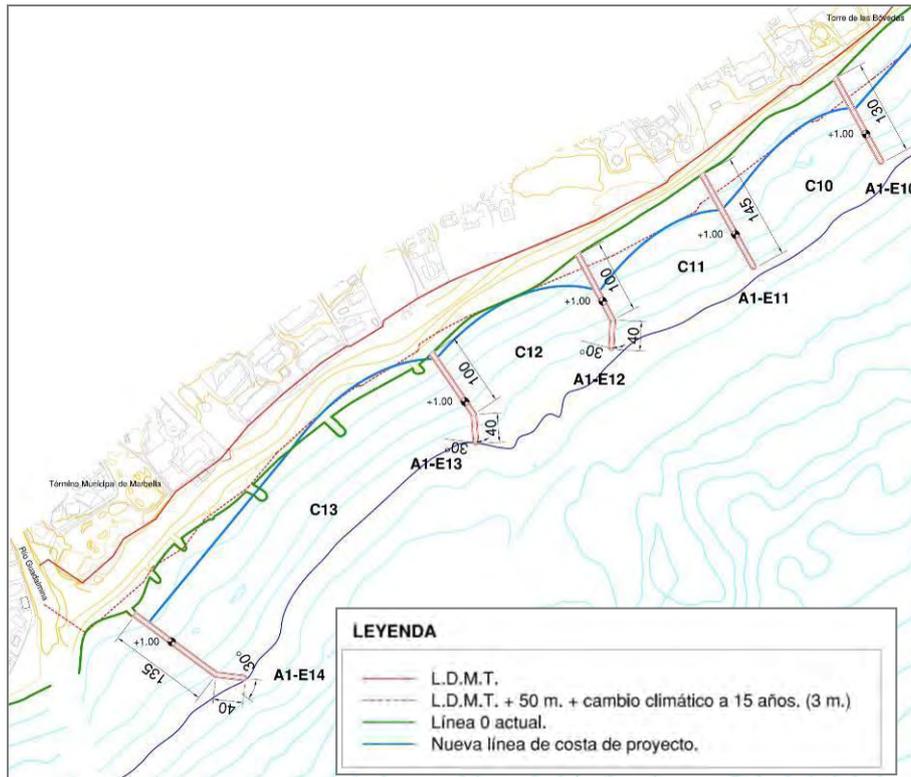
Planta Alternativa 1. Celdas C10-C13.
